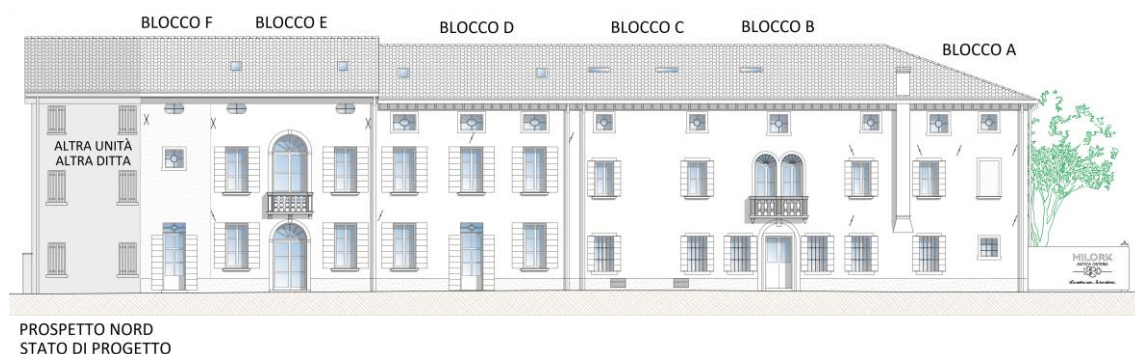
Prospetto Nord - Stato di progetto - scala generica
